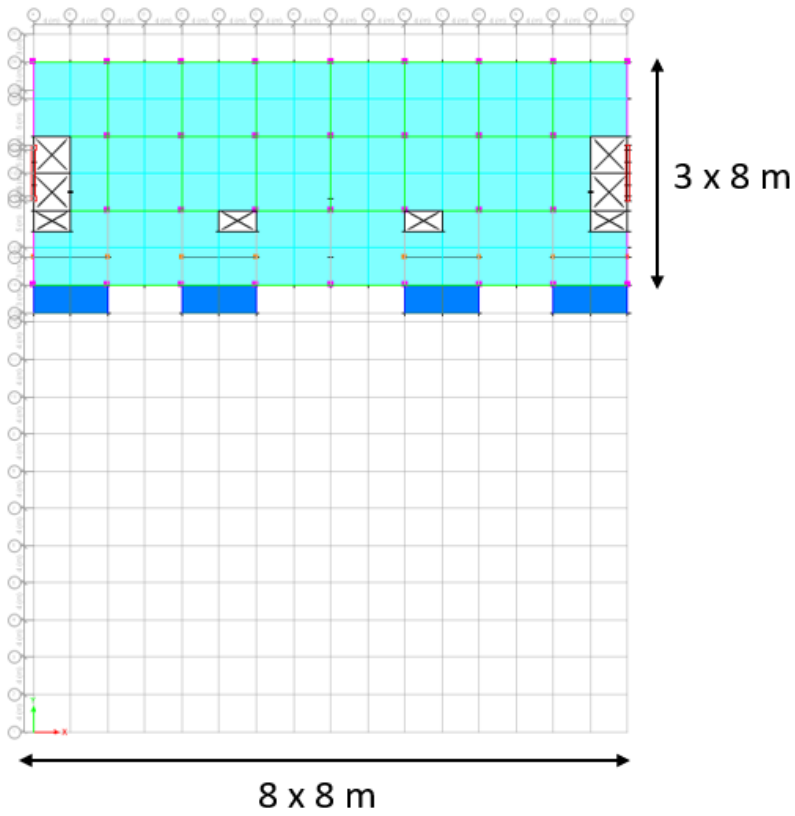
Denah Tipikal Lantai 8 dan 10 Untuk Model 1
